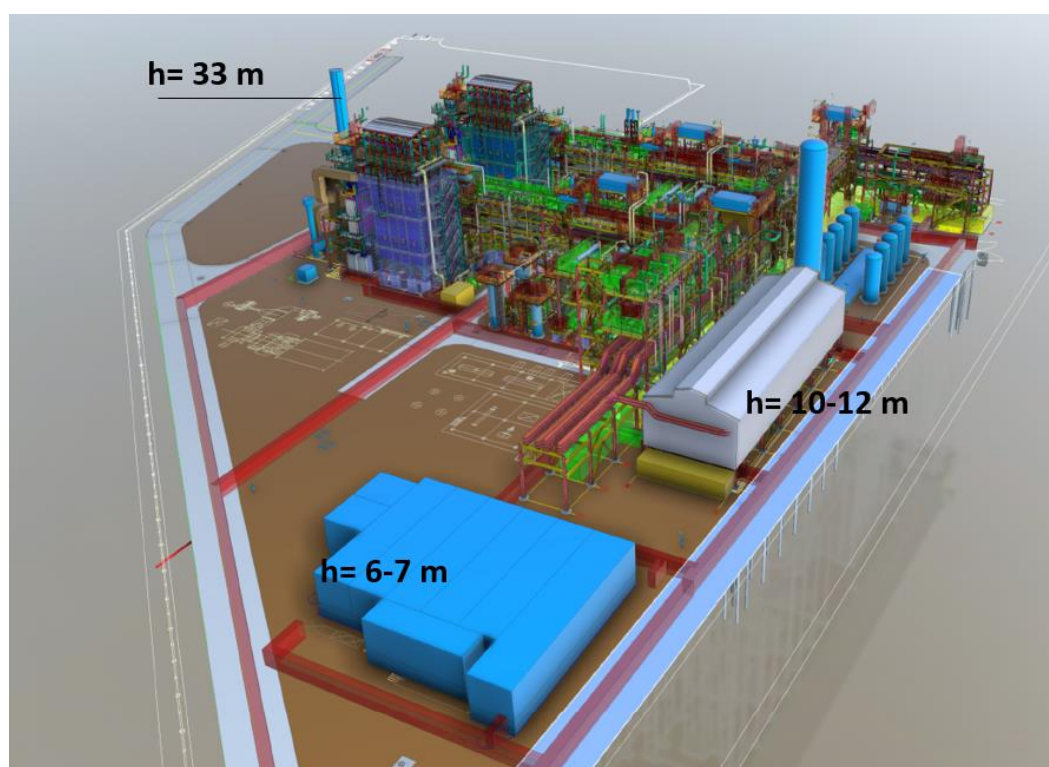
Schema impiantistico dettagliato dell'impianto di Steam Reforming in progetto (vista da E)
